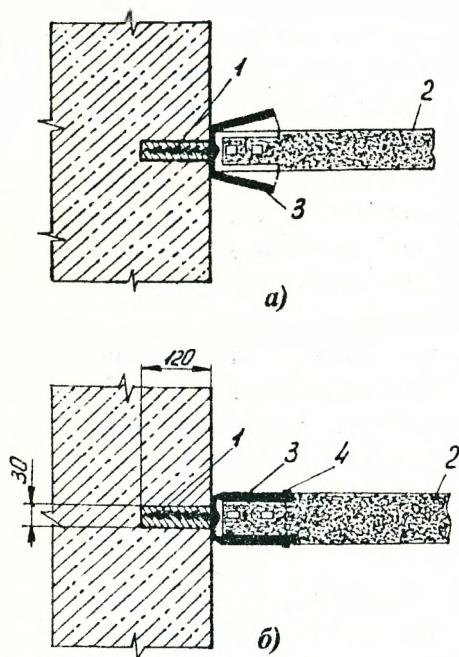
Закрепление перегородок к стене вилочной скобой.
